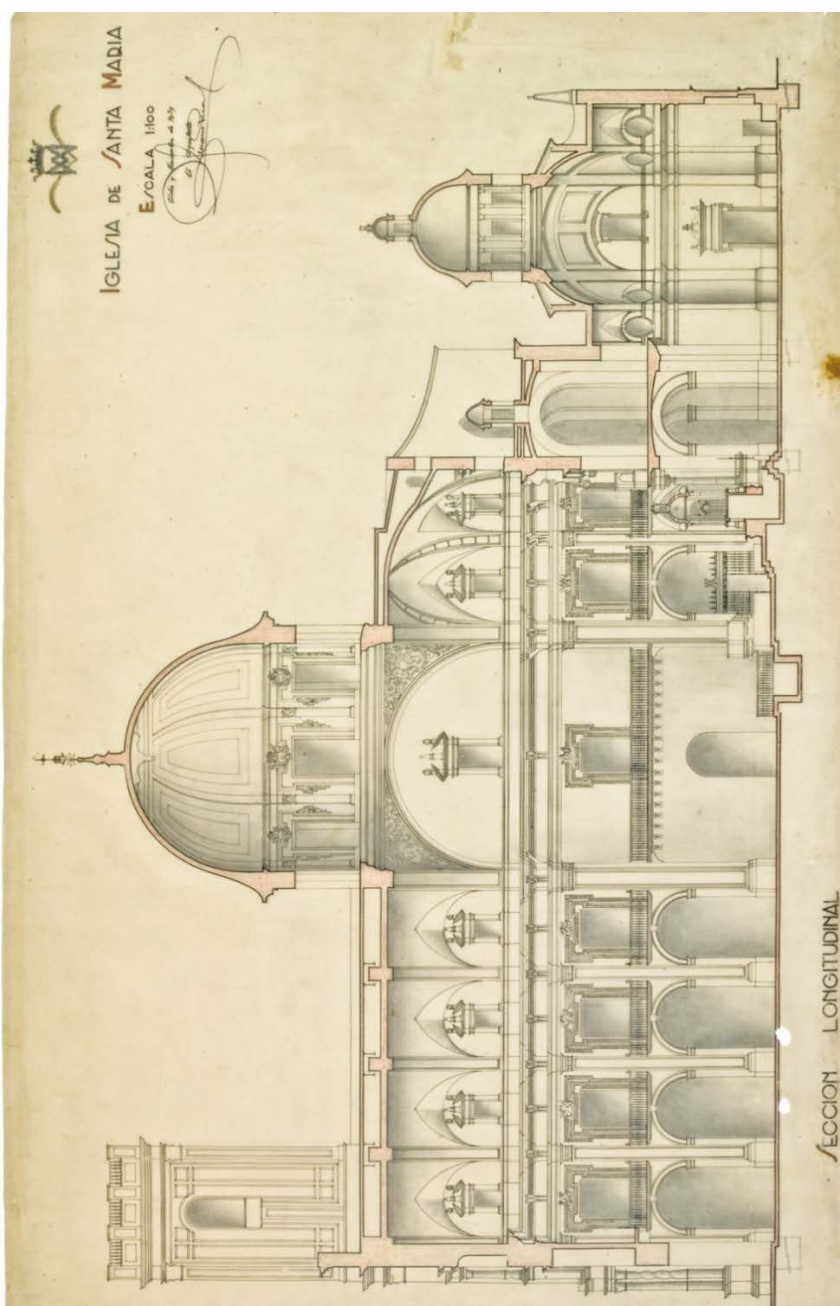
Plano de sección longitudinal. Proyecto de Restauración de la Iglesia de Santa María de Elche de Antonio Serrano en 1940 (Ajuntament d'Elx, 2010).
